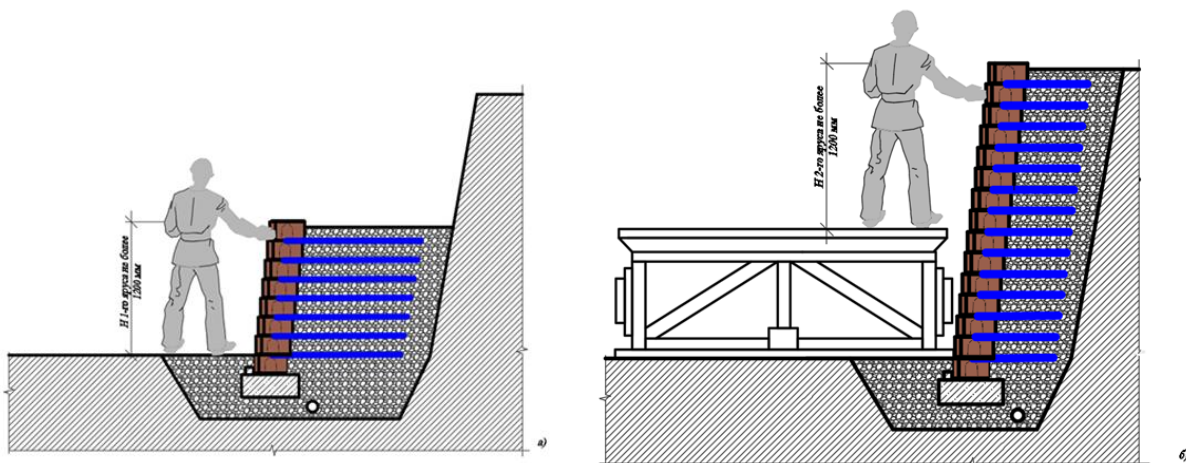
Принципиальная схема устройства подпорной стены по ярусам по первому способу: а) кладка стен первого яруса с лицевой стороны стены с щебеночной отсыпки; б) кладка стен второго яруса с подмостей
